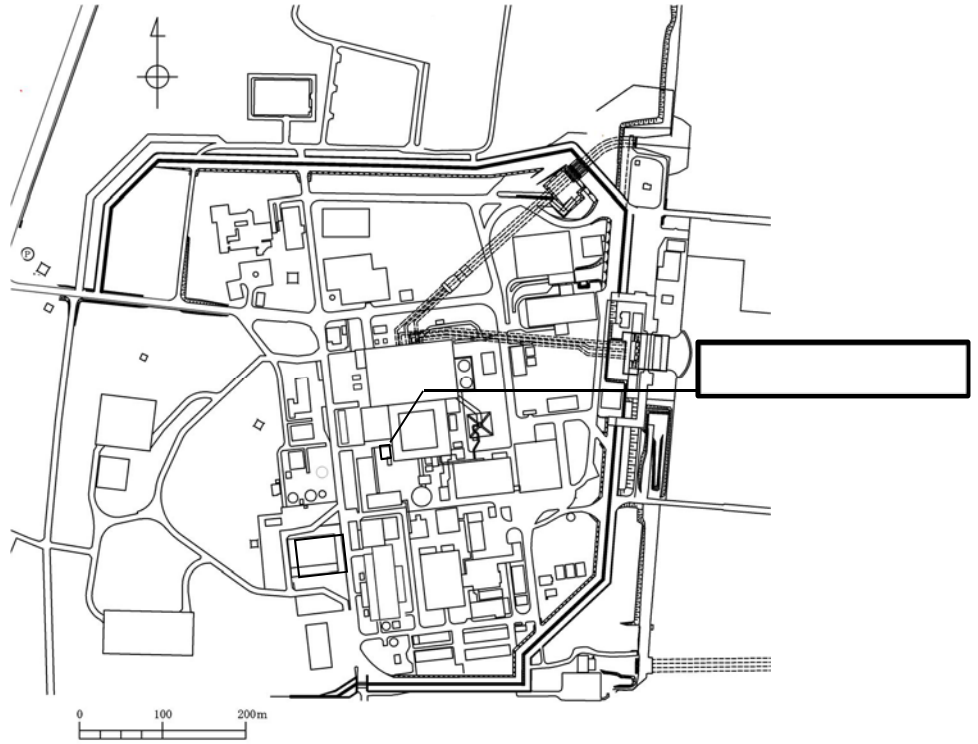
(1) 立坑の平面配置図（全体平面図）
